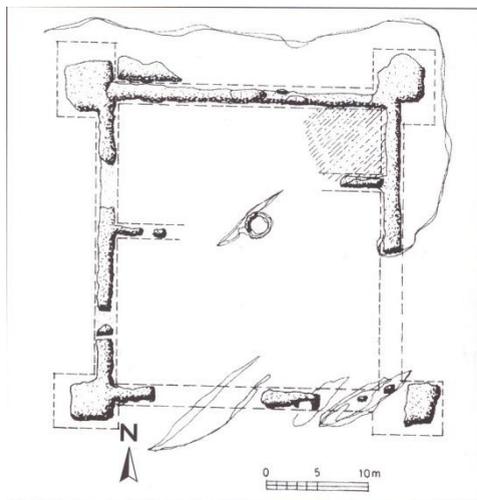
Plano de la zona arqueológica (Lucien Bayrou, 2011)
